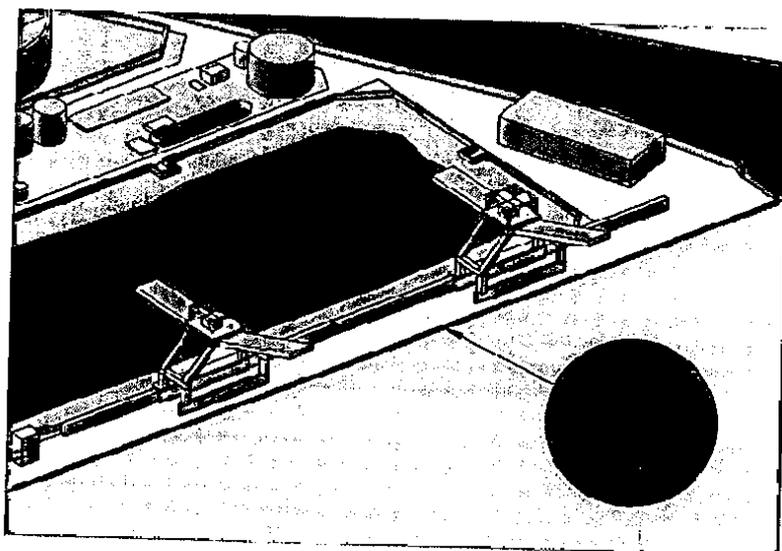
Vista dall'alto della banchina con installazione barriera di contenimento
